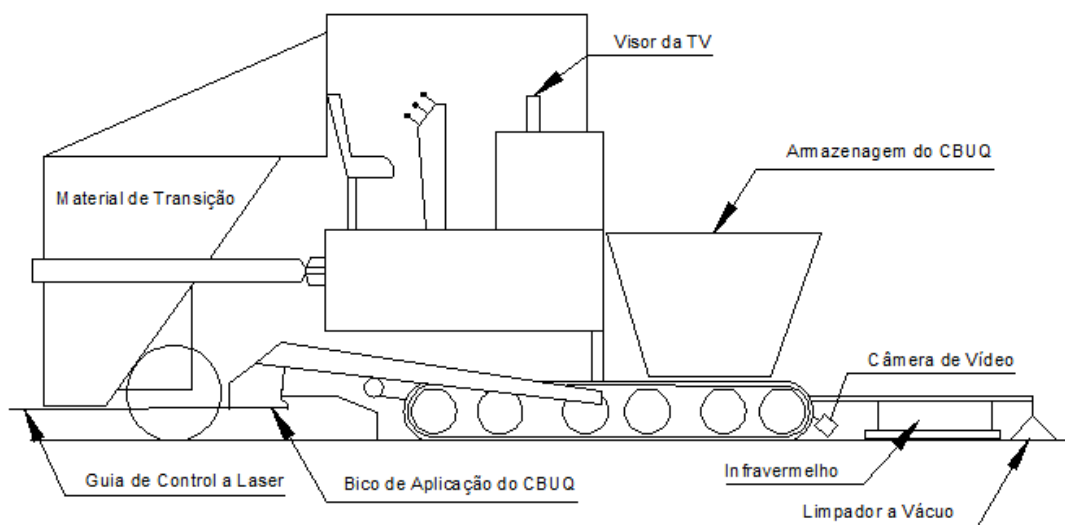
Desenho esquemático da máquina pavimentadora (modificado - Höeg, 1993).
